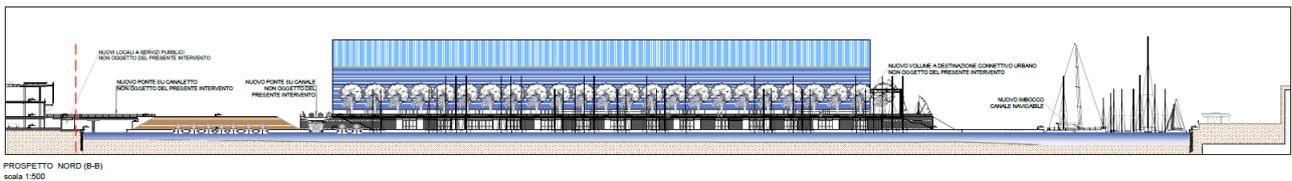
Sezione lungo il Canale Principale e prospetto del lato nord del Padiglione Nouvel (stralcio della tavola T08-D-Ar del Progetto Definitivo).
